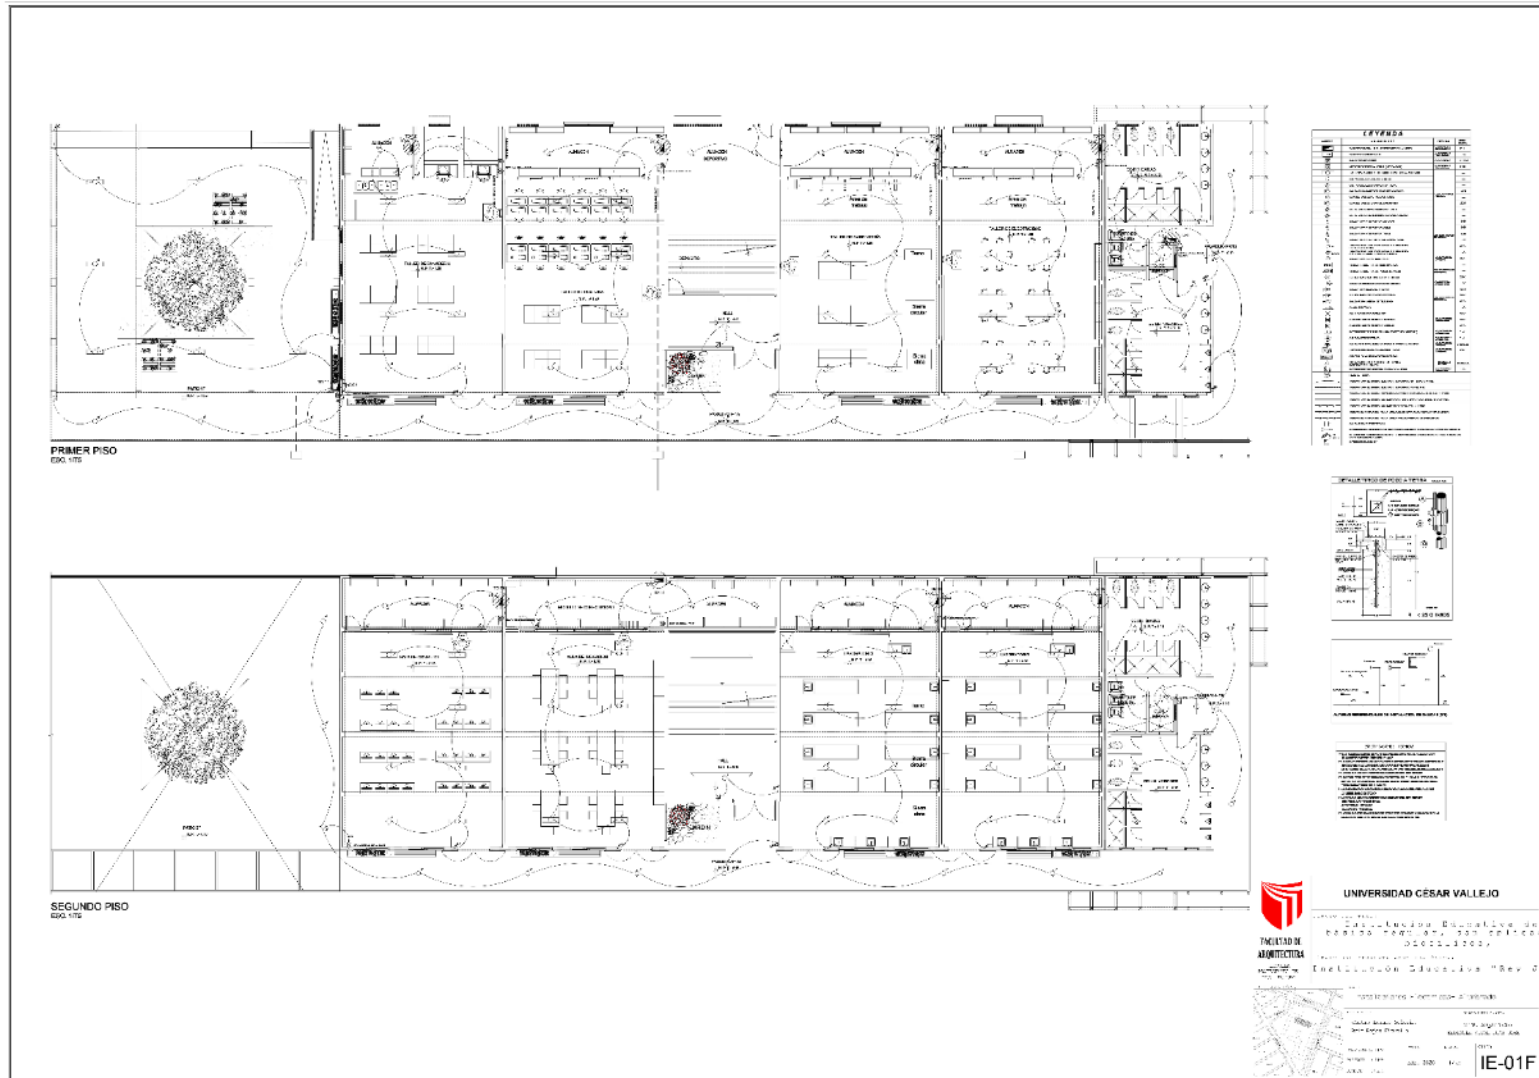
Plano alumbrado del primer y segundo nivel bloque "F", Fuente: elaboración propia
